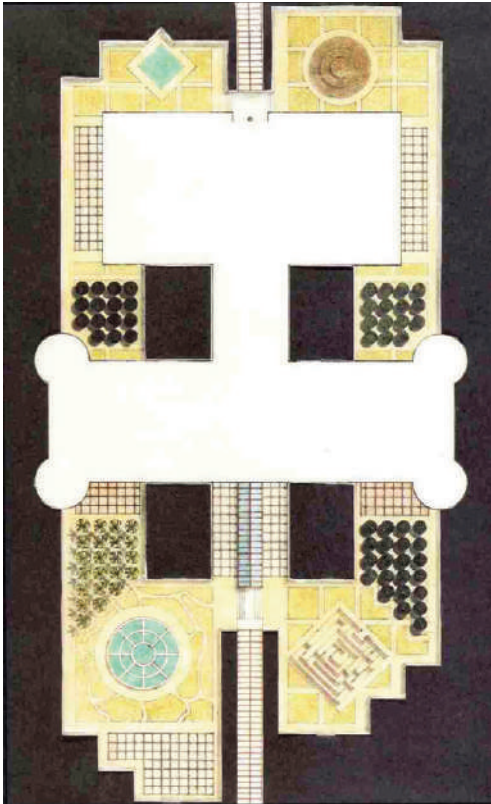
Il Nuovo Palazzo delle Finanze a Palermo: ipotesi per la pianta delle coperture (A. Sposito, 1987).
